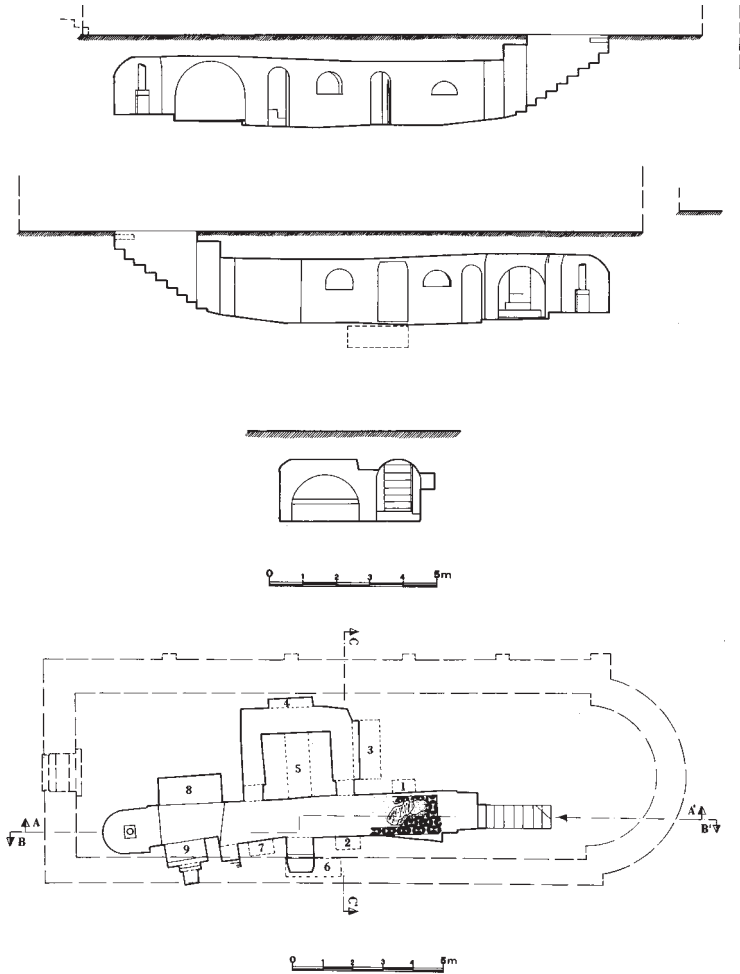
a. Fordongianus. Chiesa Vittorina di S. Lussarlu (XII sec.). Pianta e sezioni.
